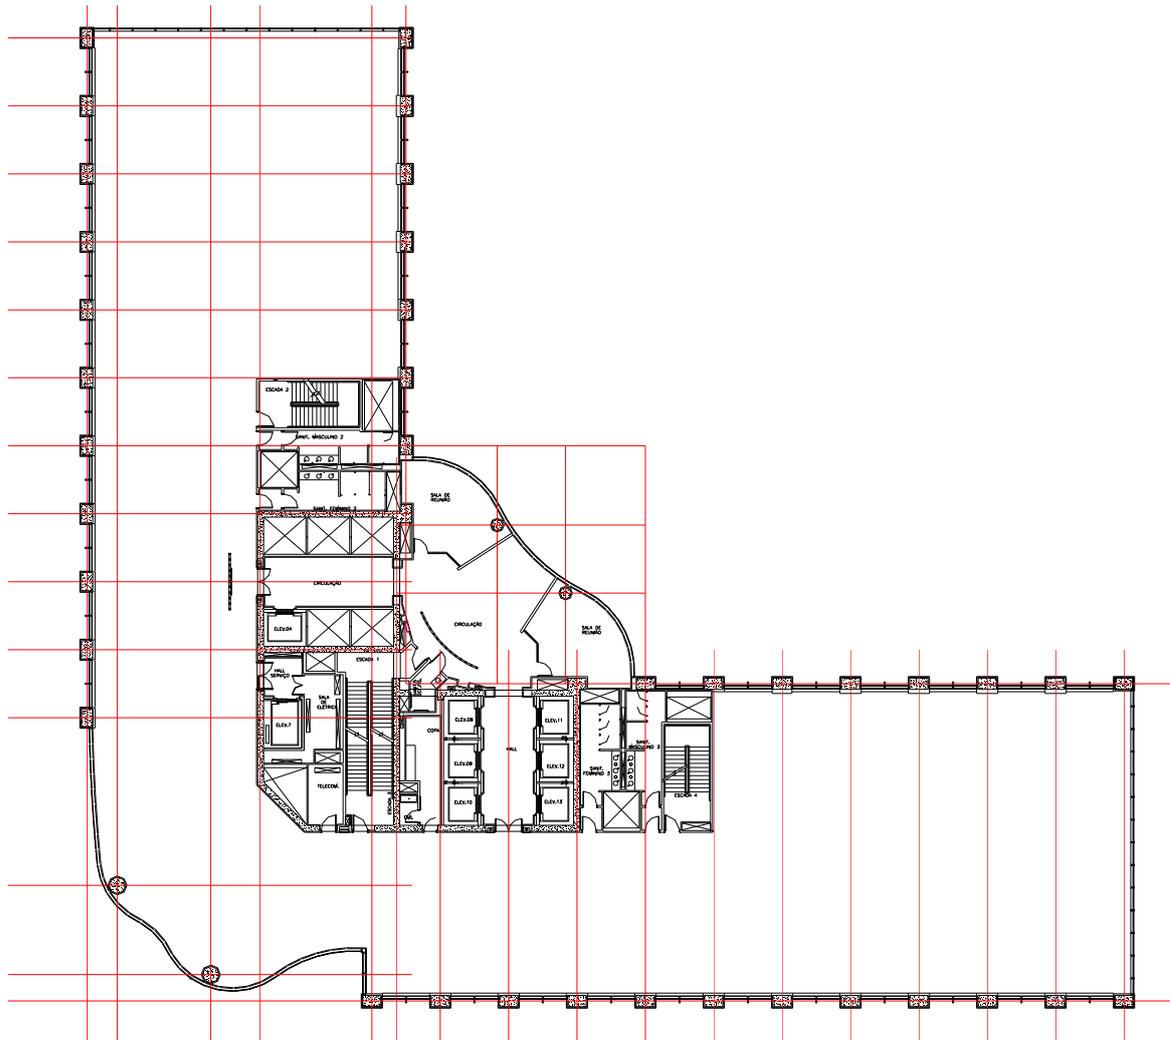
Planta do 3º pavimento com 2.462 m<sup>2</sup> de área construída
